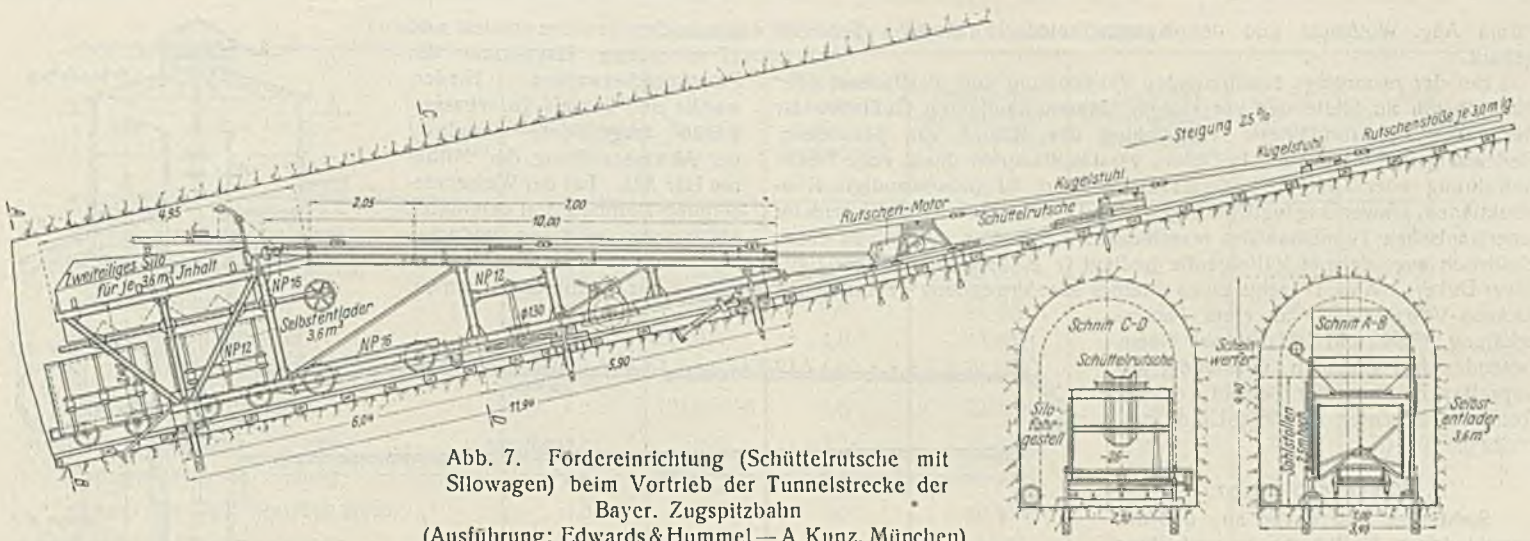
Fördereinrichtung (Schüttelrutsche mit Silowagen) beim Vortrieb der Tunnelstrecke der Bayer. Zugspitzbahn (Ausführung: Edwards & Hummel — A. Kunz, München).
